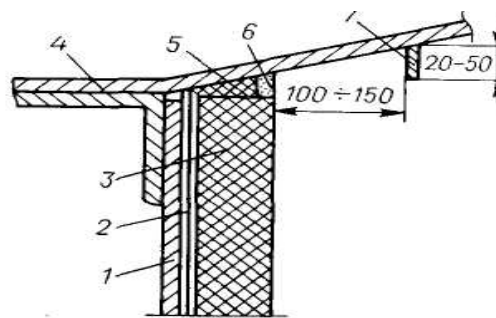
Узел защиты стыка корпуса и несъемной крышки из коррозионно-стойкой стали: 1 - корпус из углеродистой стали; 2 - непроницаемый подслой; 3 - футеровка корпуса; 4 - крышка несъемная из коррозионно-стойкой стали; 5 - шнур асбестовый с кислотостойкой замазкой; 6 - разделка кислотостойкой замазкой; 7
